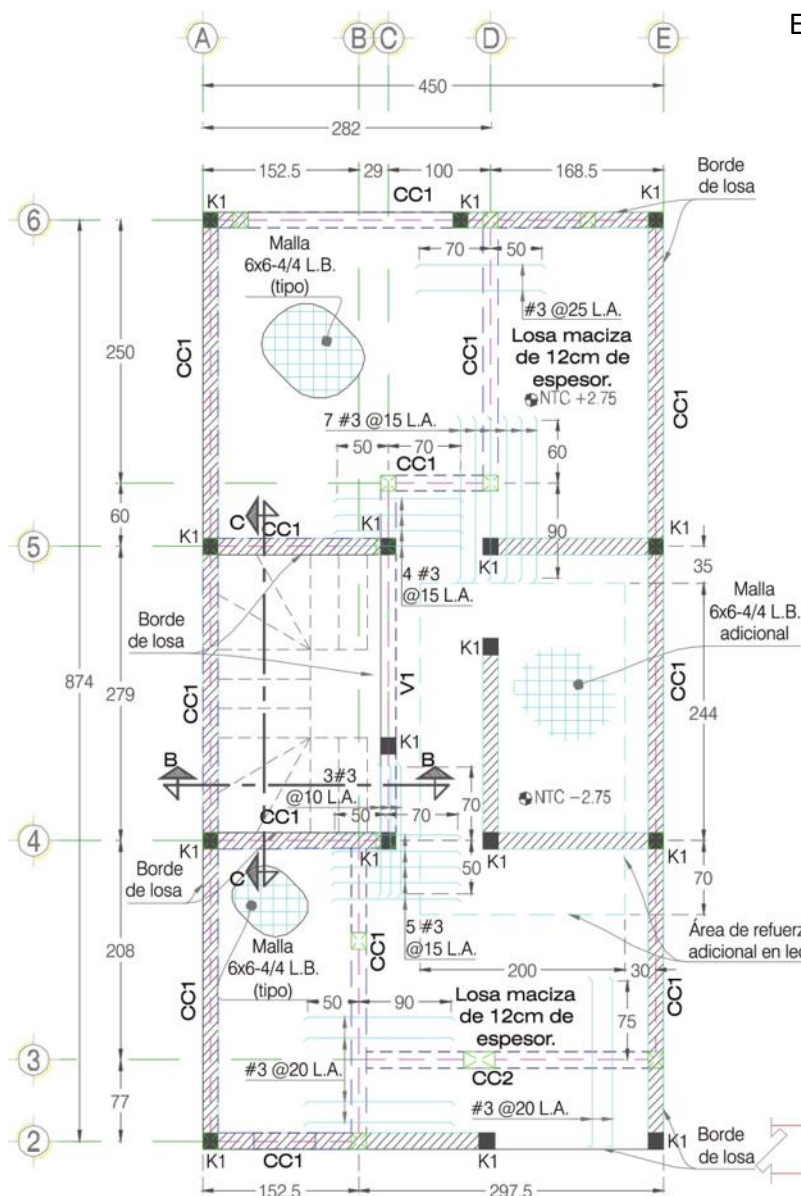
PLANTA DE ENTREPISO (SAUCE).
